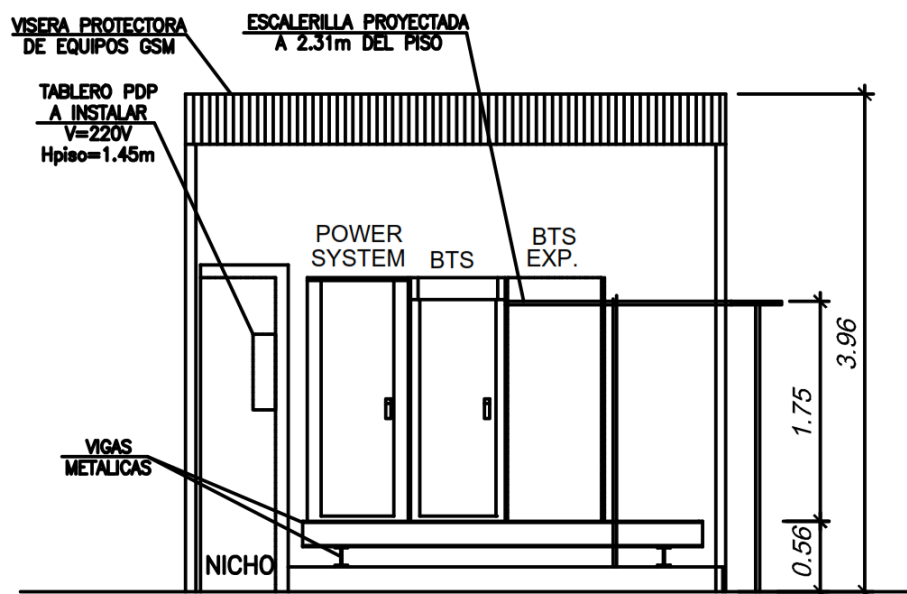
Vista Lateral de Alzado de Equipos RBS.
